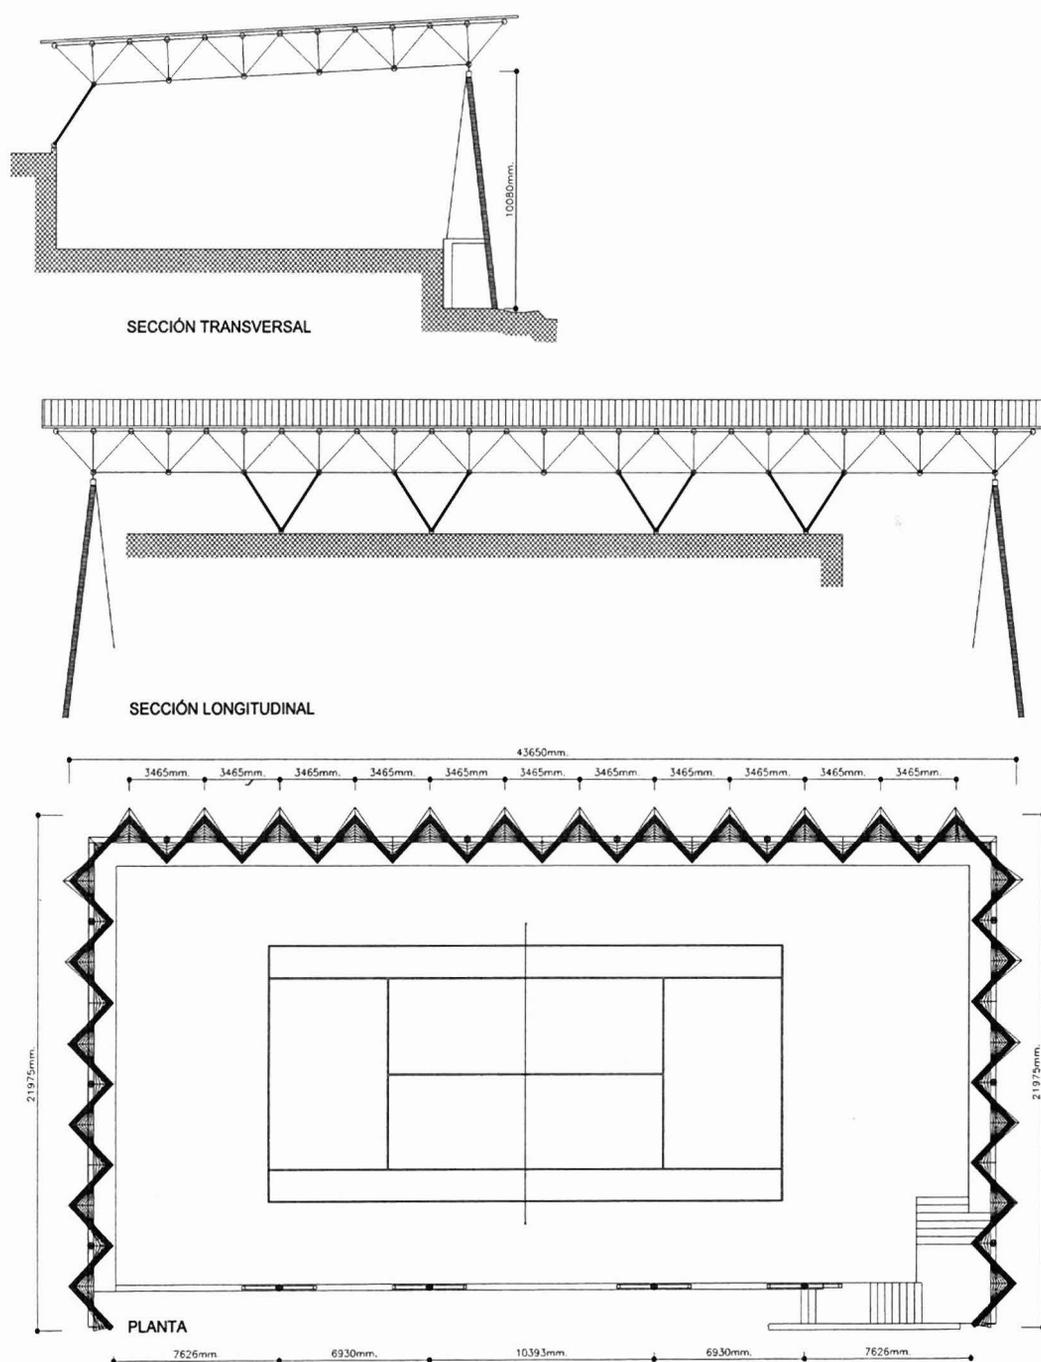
Planos de planta y sección de los muros portantes de cerámica armada.
